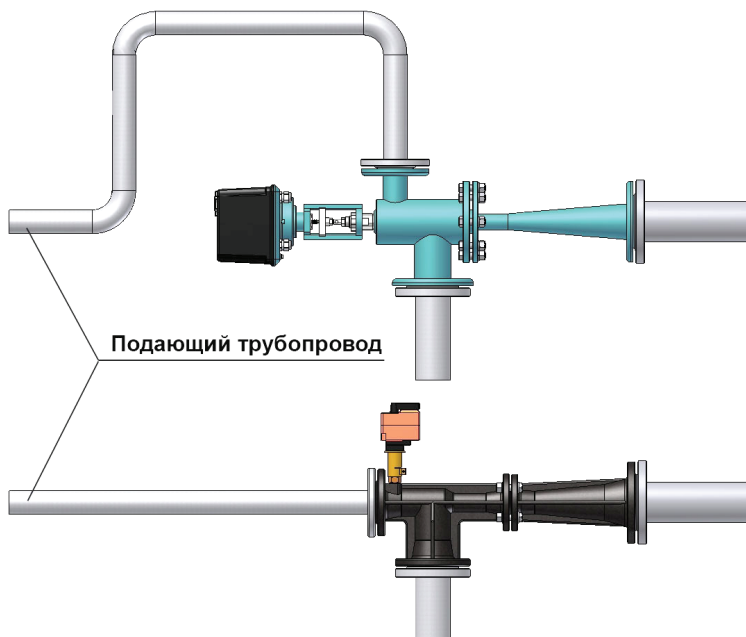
Сравнительная схема монтажа регулируемого гидроэлеватора «Этон» и ВАРС (корпус черного цвета)
